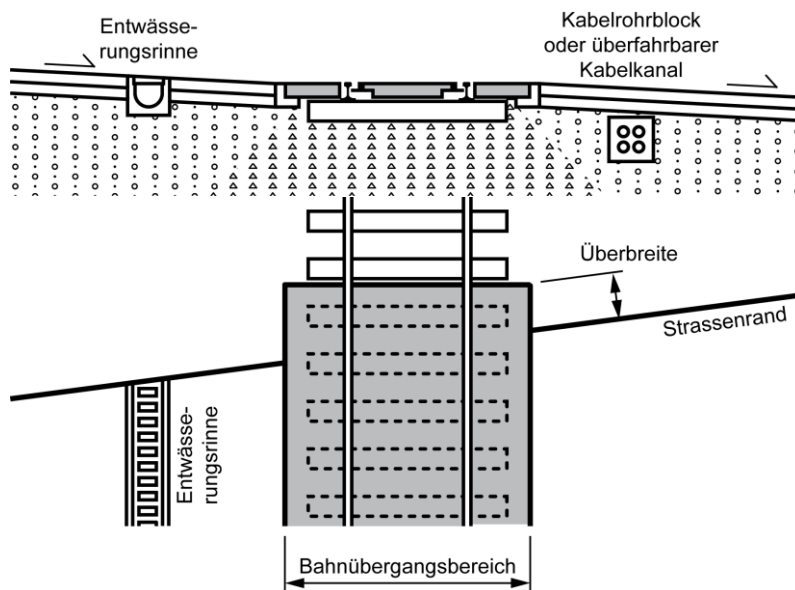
Oberbau mit Gummi- oder Betonplatten (Beispiel für Schnitt und Grundriss)
